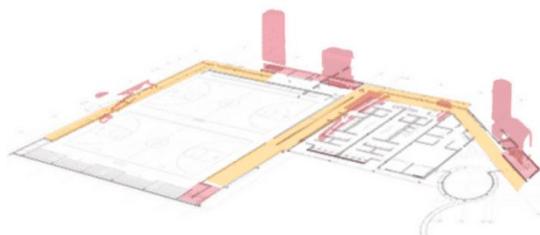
Circulación y recorrido continuo. Elaboración grupal de taller avanzado
